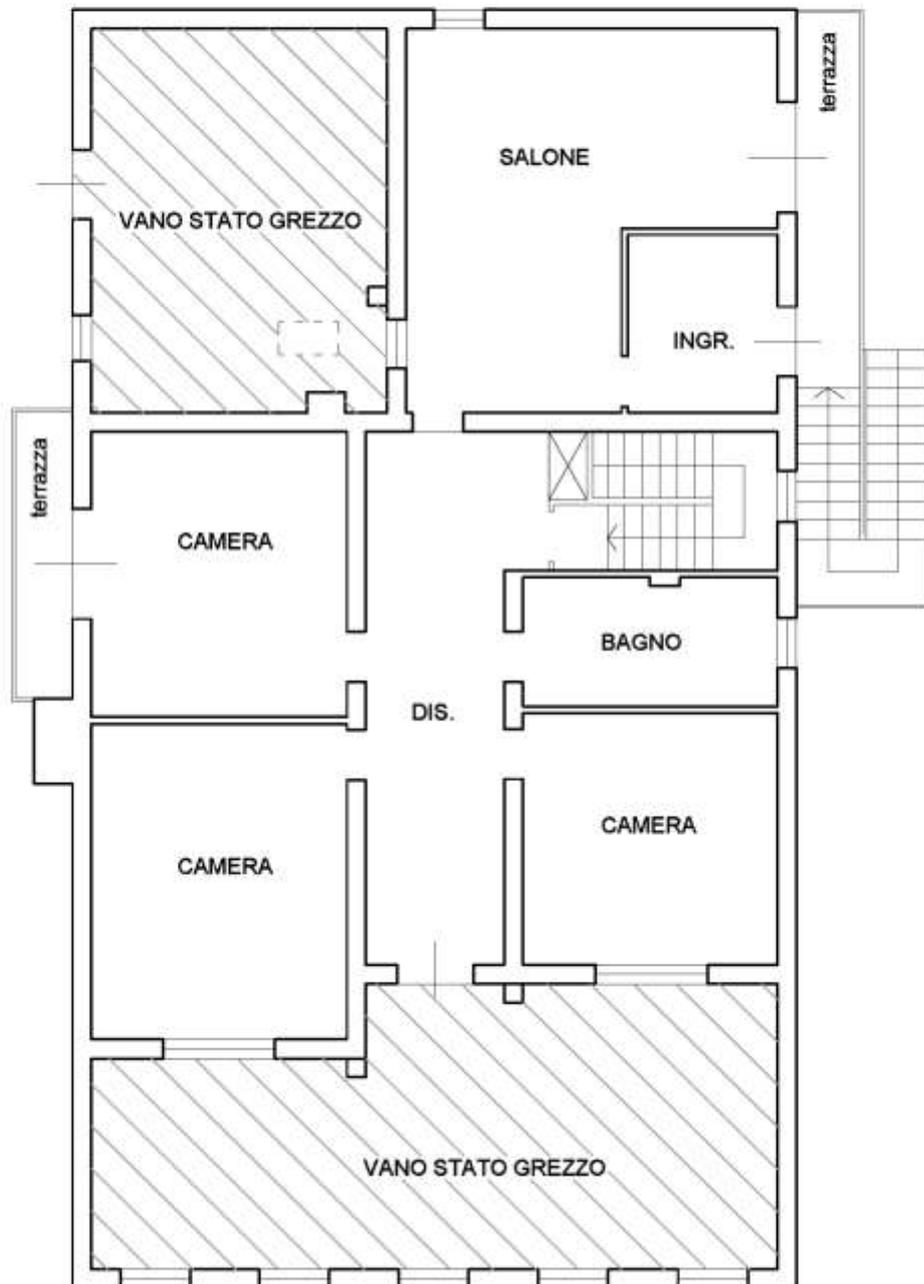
SCHEMA A VISTA piante abitazione (fuori scala) stato ATTUALE
